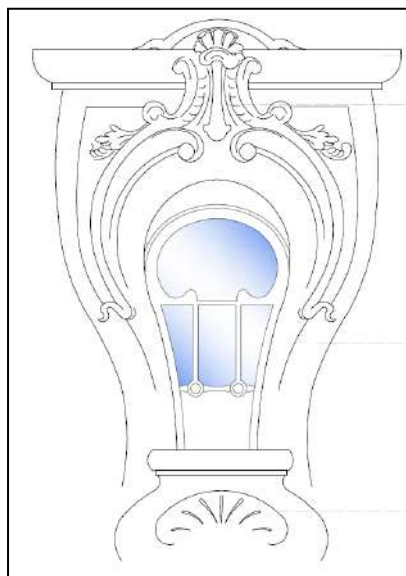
a. Fenêtre de la section d'angle de la façade N59/61. Style Art Nouveau.
